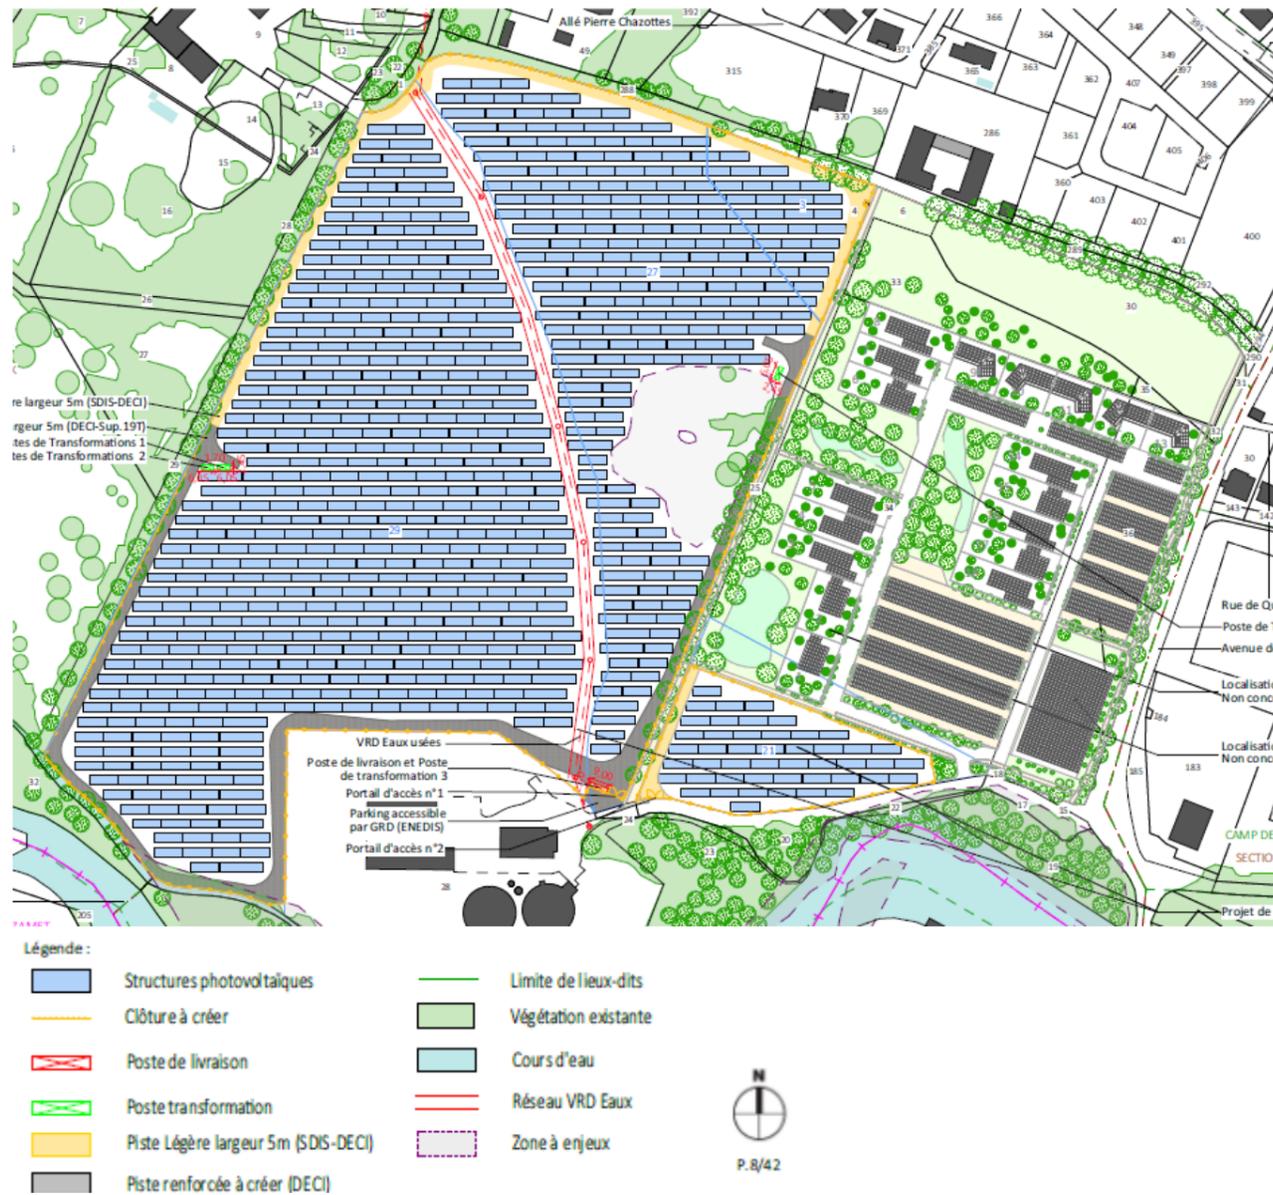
Plan de masse de avril 2023 (source : Watt&Co Ingénierie)
